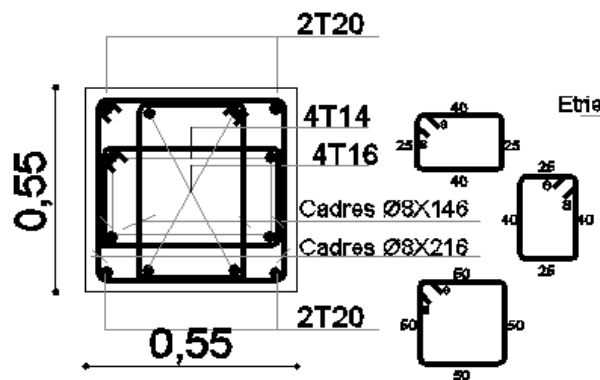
Schéma du ferrailage du poteau 55x55
